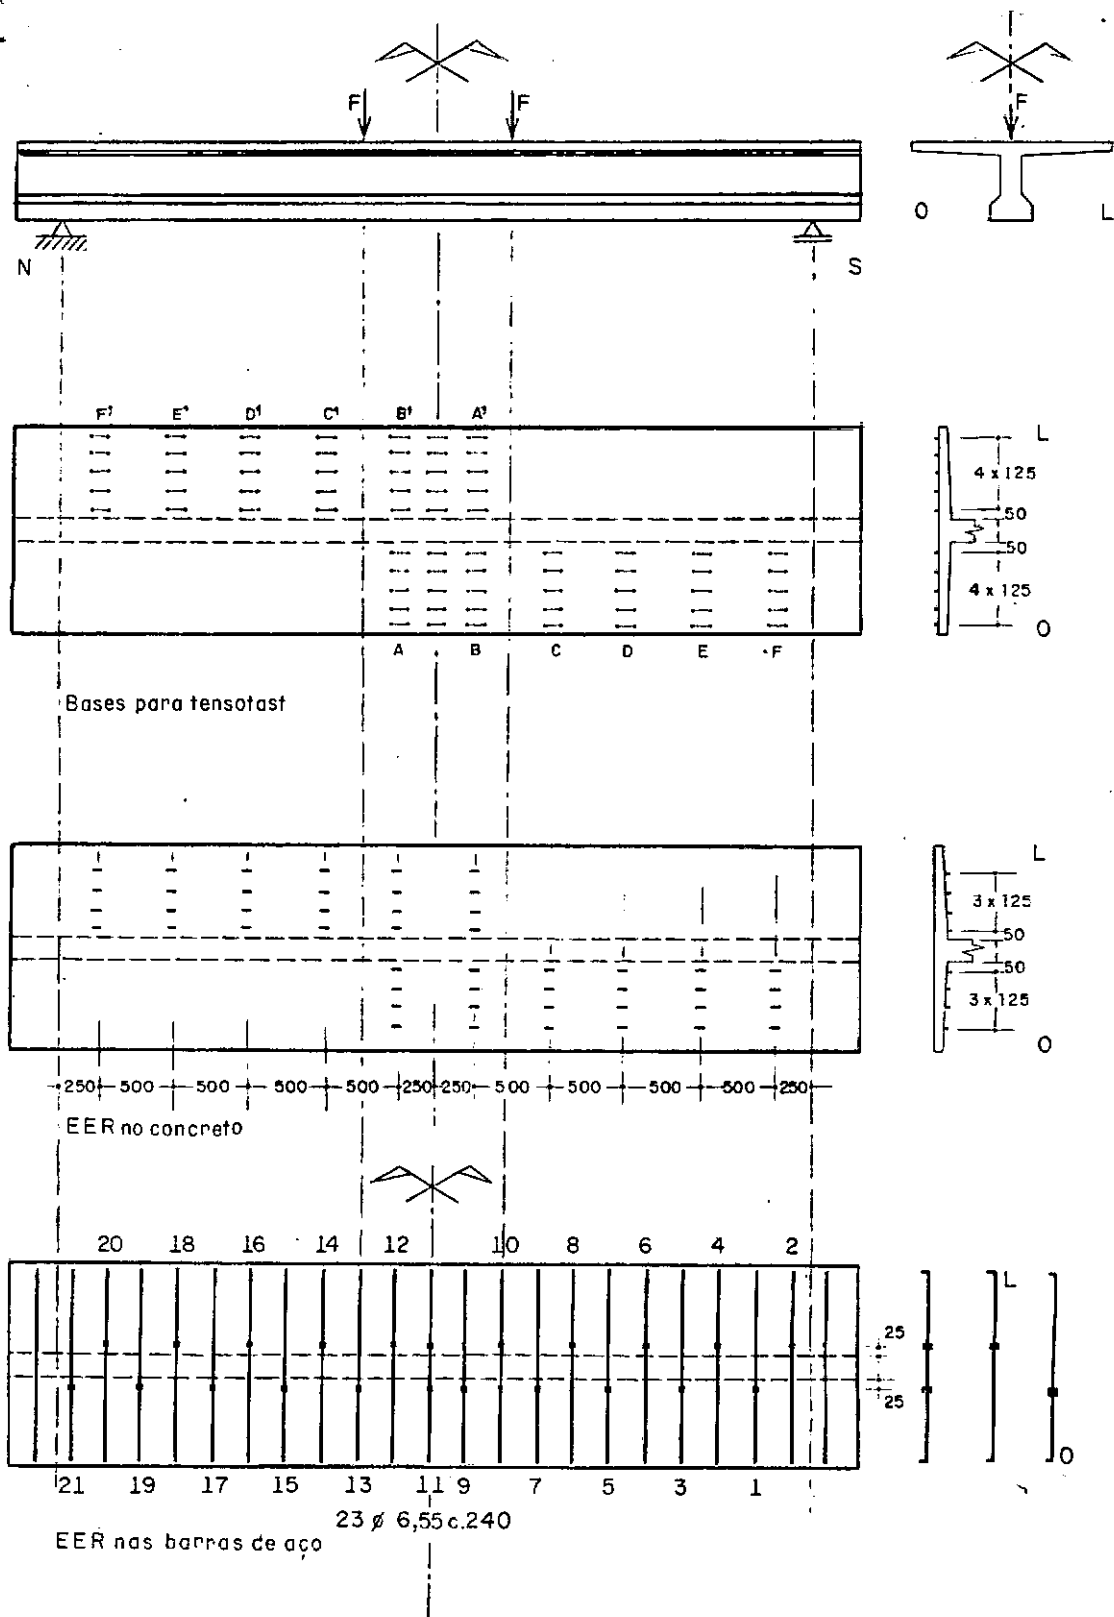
a - Instrumentação da viga T1 - (cotas em mm)
